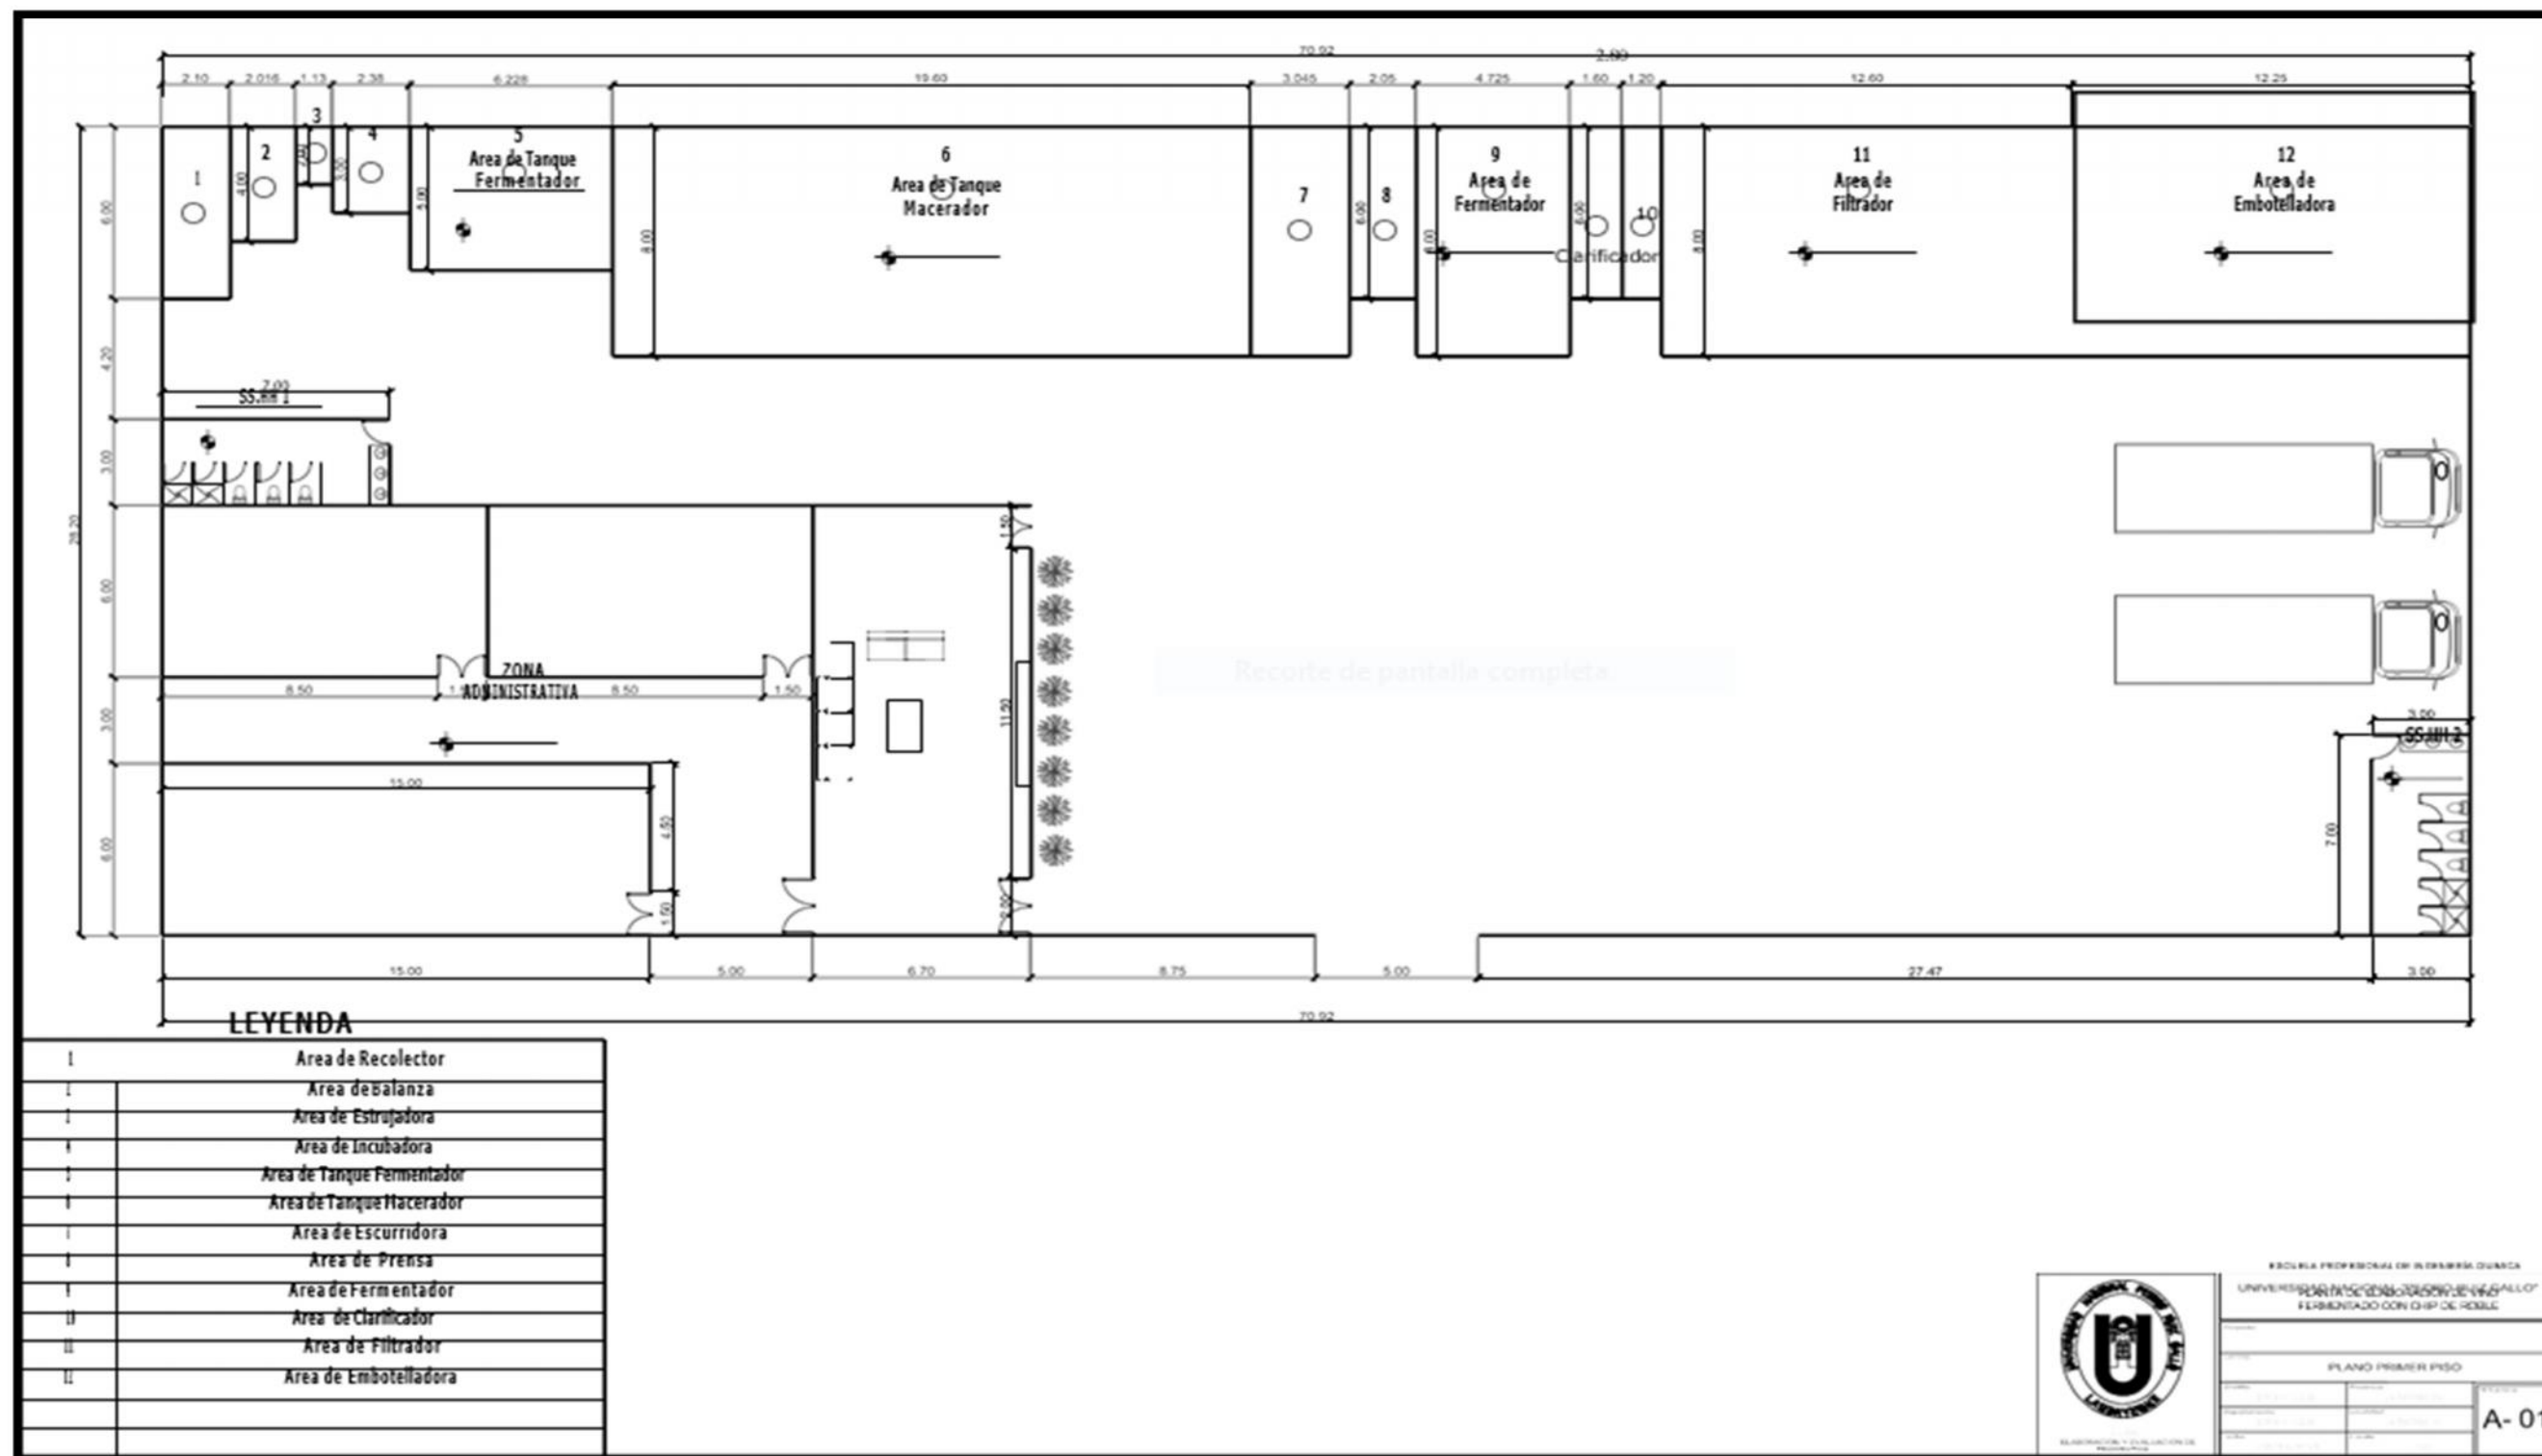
Plano de la distribución de planta, Elaboración propia (2018)
